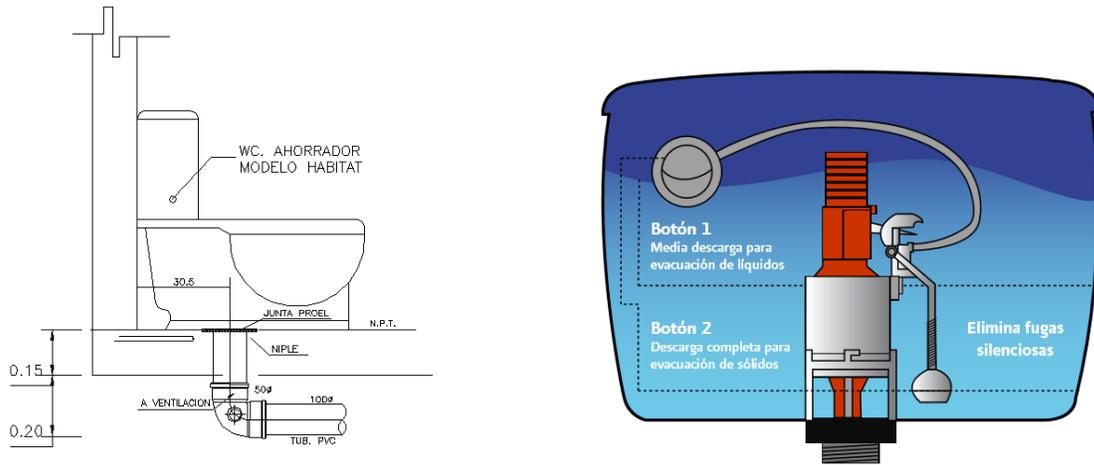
Detalle de planta de instalación sanitaria del proyecto. Fuente: Promovente.
